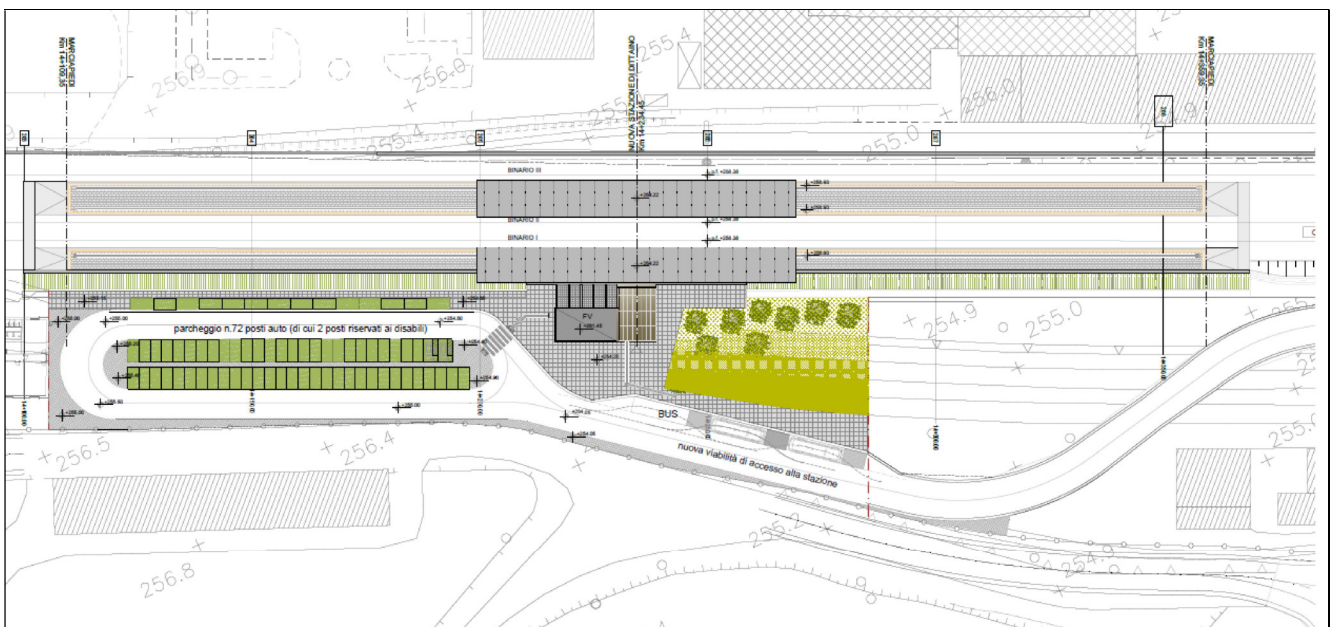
Stazione di Dittaino: Stralcio planimetrico
